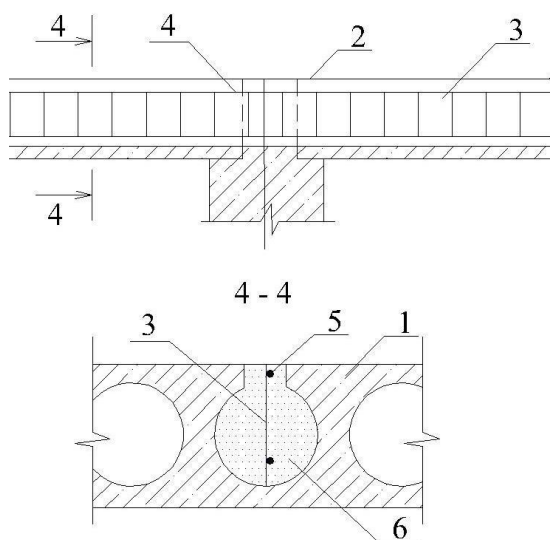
Створення нерозривності встановленням арматурних каркасів. 1 – підсилювані плити; 2 – опора (блок або балка); 3 – арматурний каркас з подвійною робочою арматурою; 4 – отвір, вирубаний у стіні для встановлення арматурного каркаса; 5 – верхня робоча арматура каркаса; 6 – отвір заповнений бетоном підсилення
